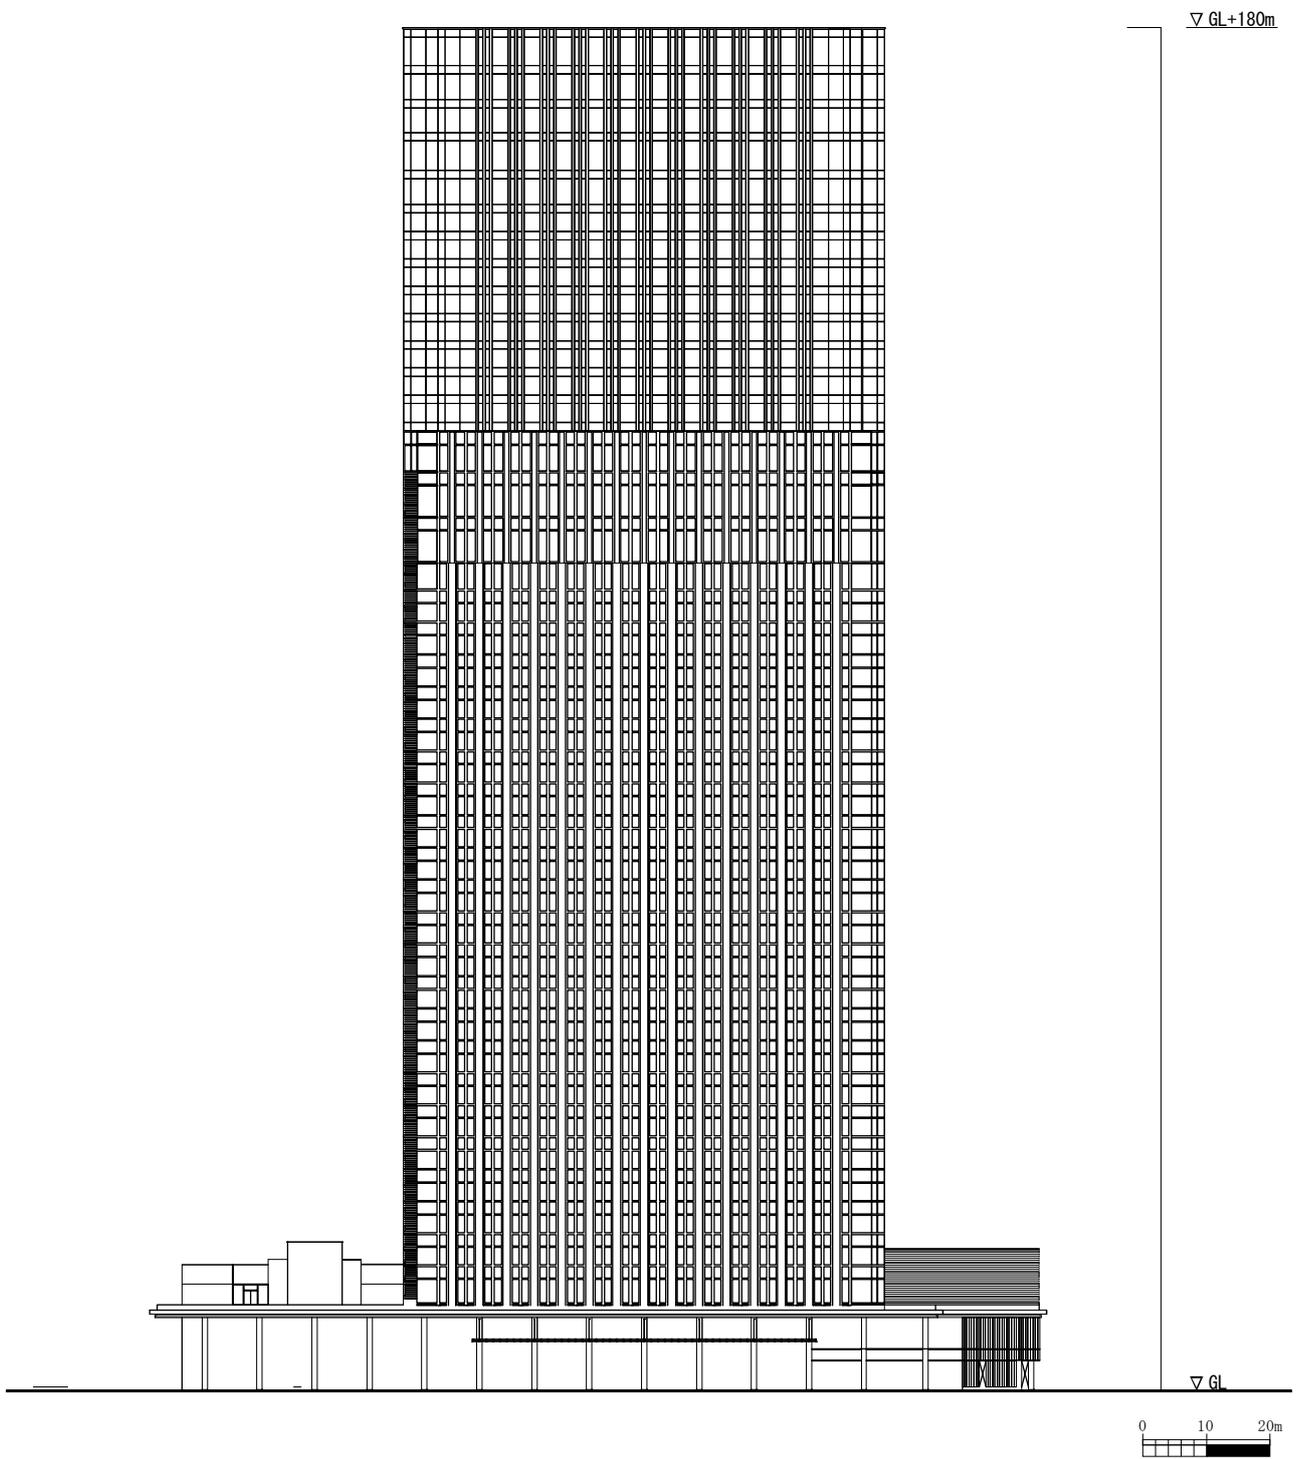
(2) 計画建築物立面図 (東側) (評価書(計画))
